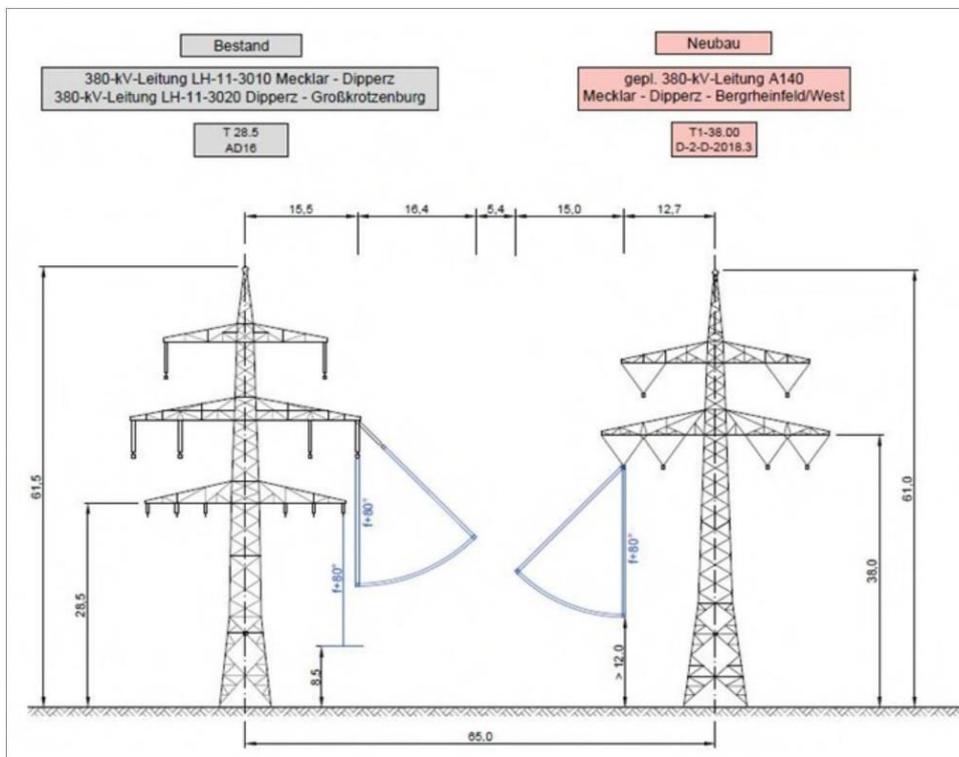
Parallelführung einer 380-kV-Neubautrasse neben der 380-kV-Bestandstrasse (alle Maße in m)
